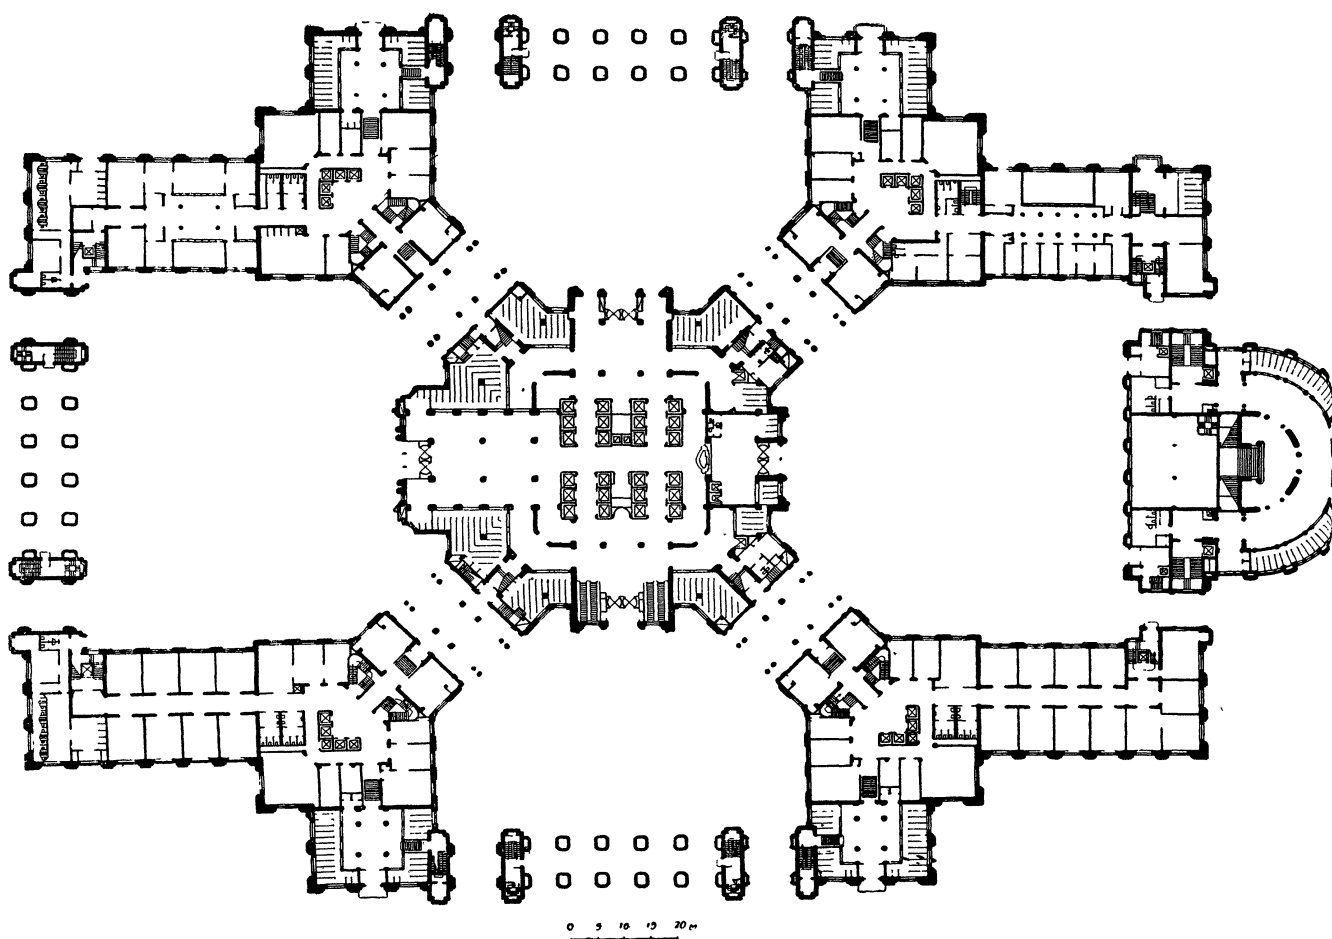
32-этажное административное здание в Зарядье. План нижнего объема (до 6-го этажа)
